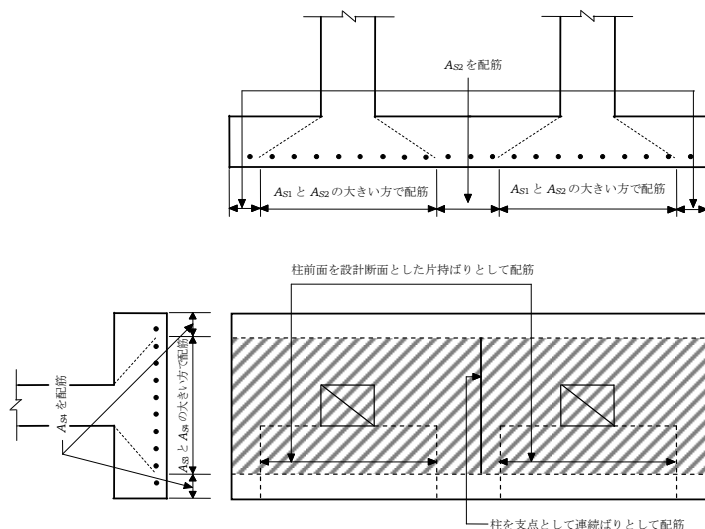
連続フーチングの鉄筋の配置 (フーチング下面側が引張りになる場合)
